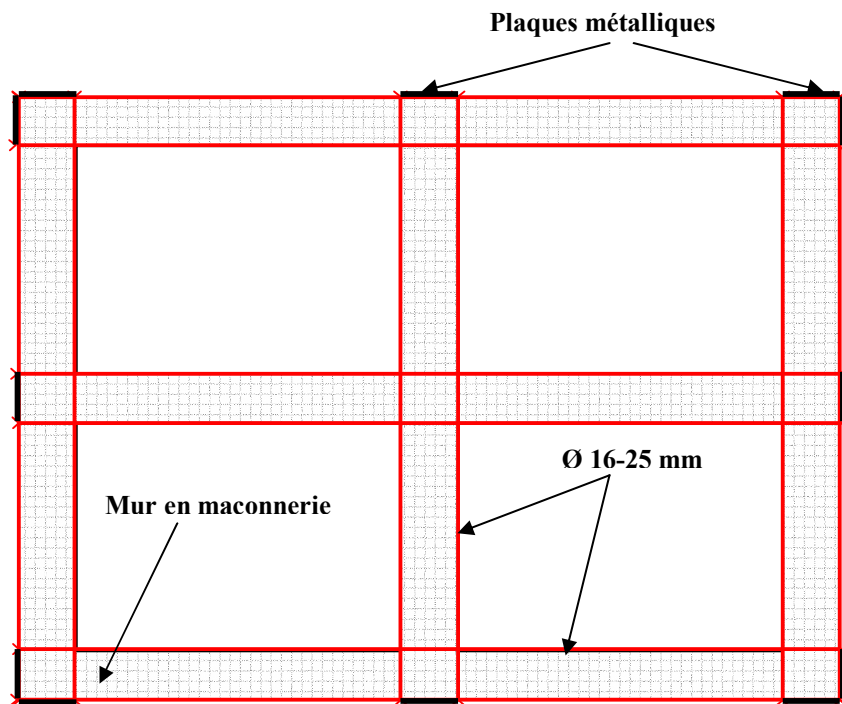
Vue en plan d'un schéma de renforcement par corsetage
